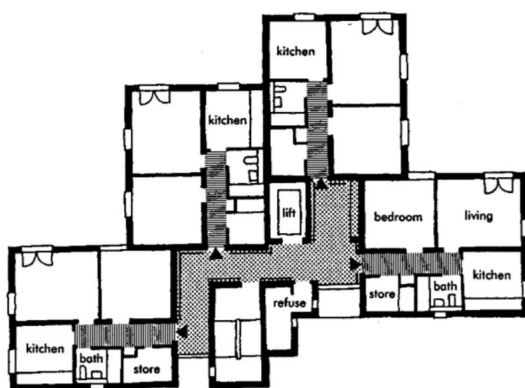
Flat di Thamesmead, London: Memiliki 4 kamar per lantai (Ars: GLC Architect's Department)
